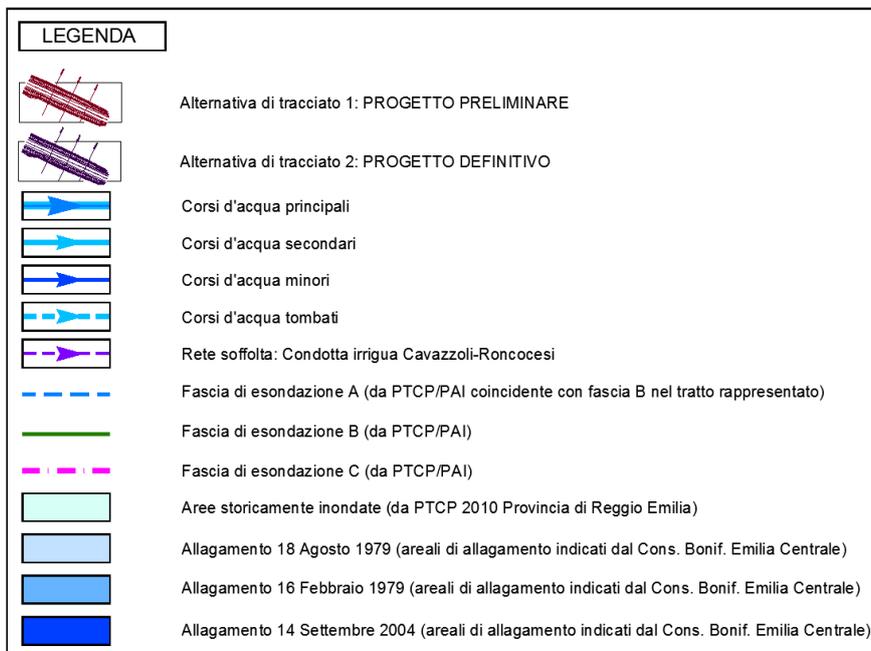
Legenda della Planimetria con alternative di tracciato a confronto
